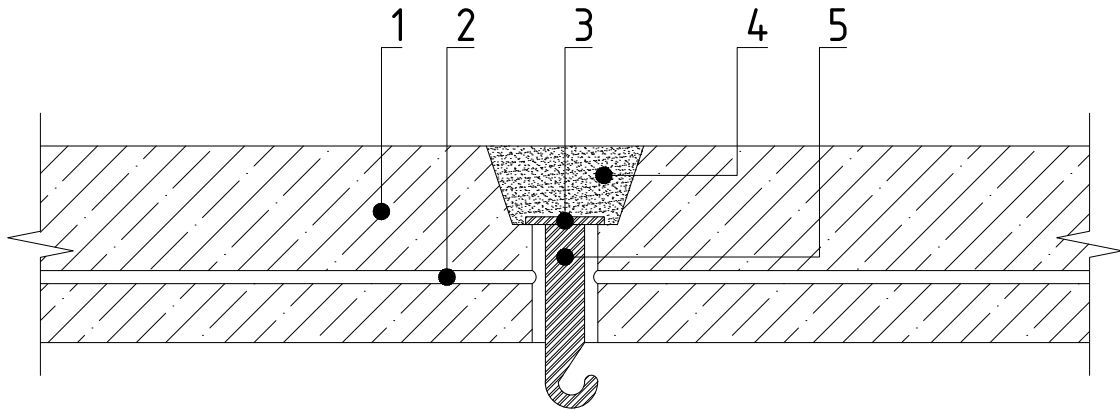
Схема конструктивного решения выпуска провода из перекрытия к поточному светильнику (перекрытие со сквозным отверстием)
